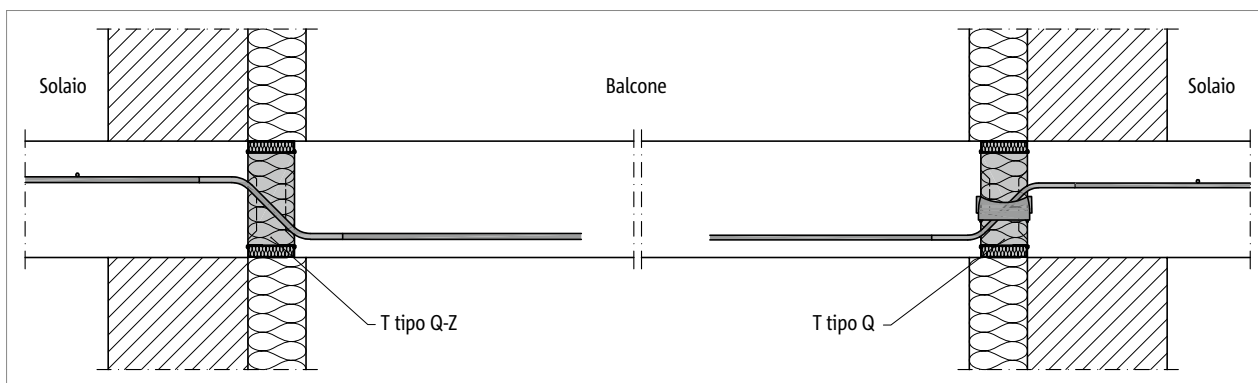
Schöck Isokorb® T tipo Q-Z, Q: caso applicativo soletta in calcestruzzo armato monodirezionale
